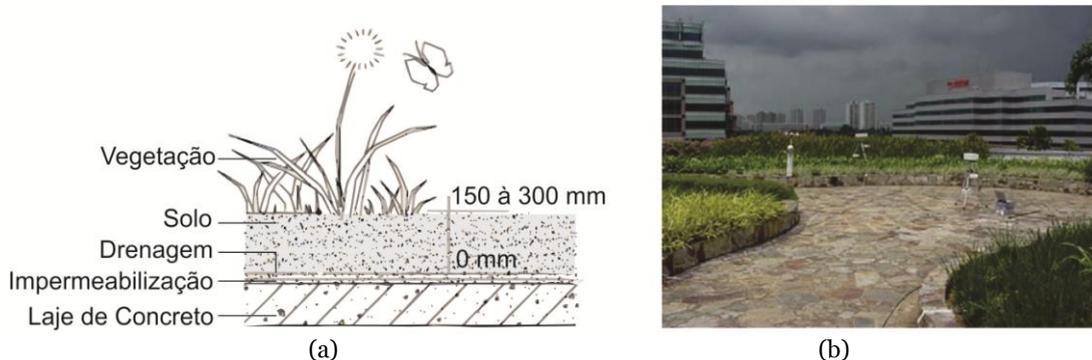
(a) Detalhe das camadas de telhado vegetado intensivo e (b) Exemplo de telhado vegetado de sistema intensivo em Singapura.
